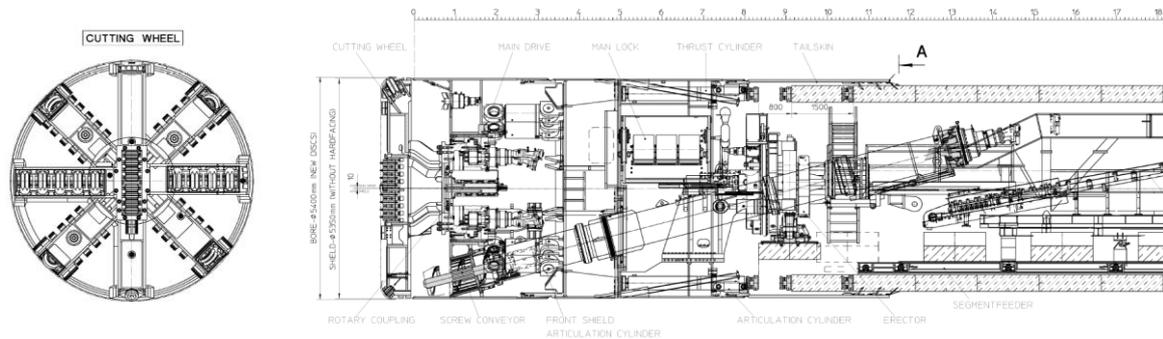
Schema della TBM tipo per lo scavo della galleria di derivazione
